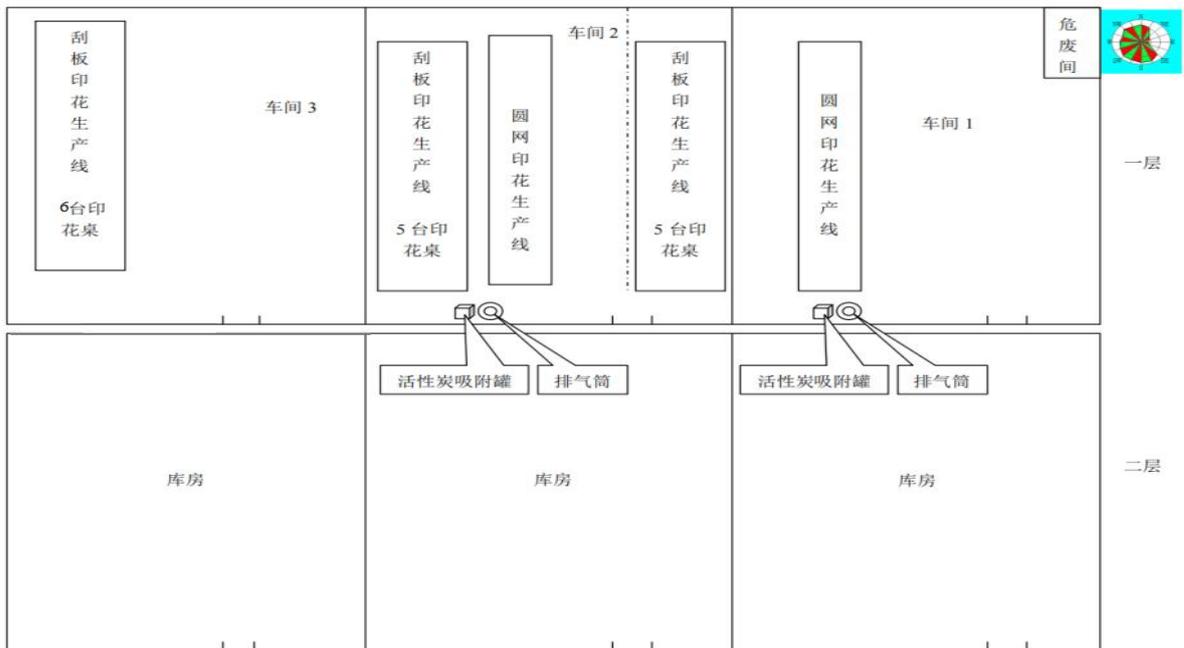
现有项目生产车间总平面布置图（比例 1:1000）
